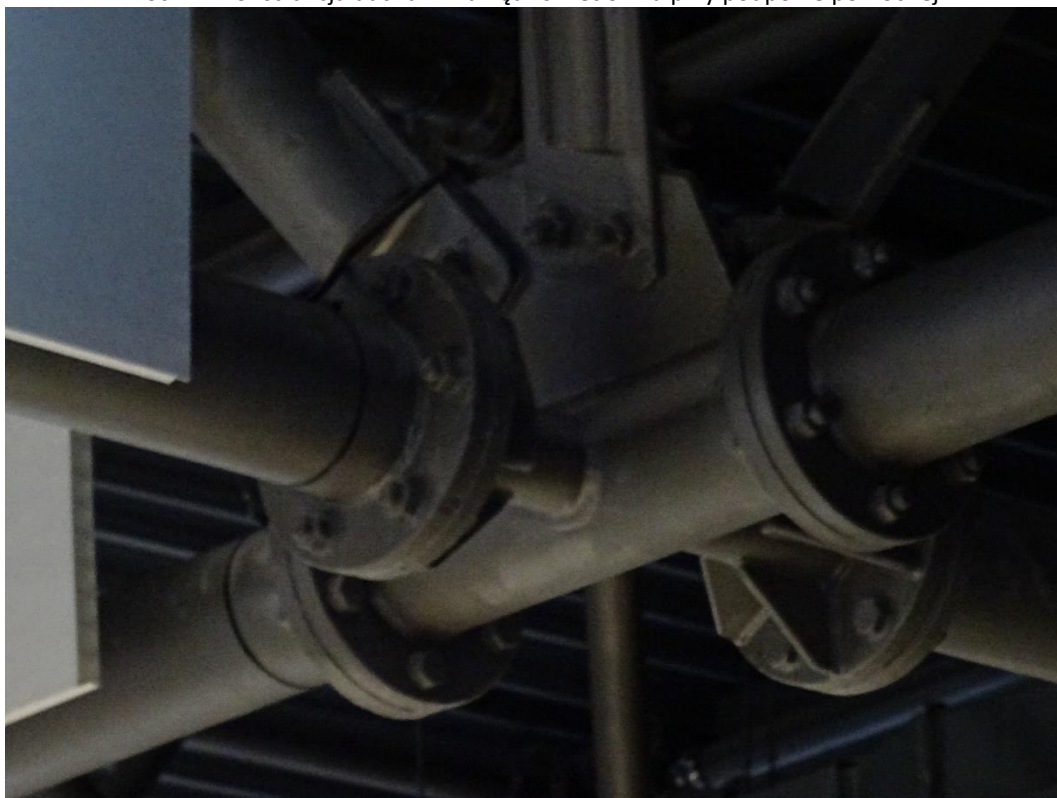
Konstrukcja dachu – część środkowa (światlik)
